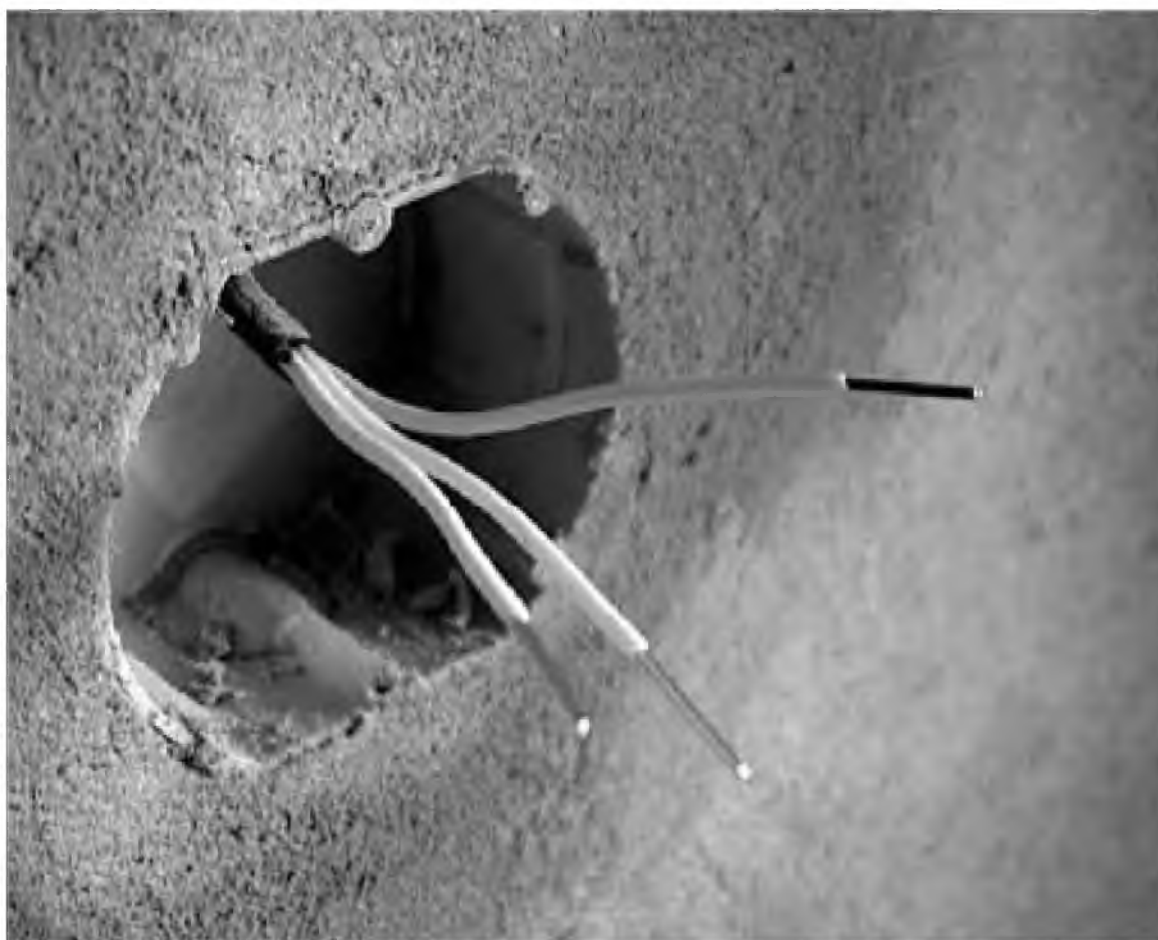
Отверстие в бетонной стене для установки розетки
